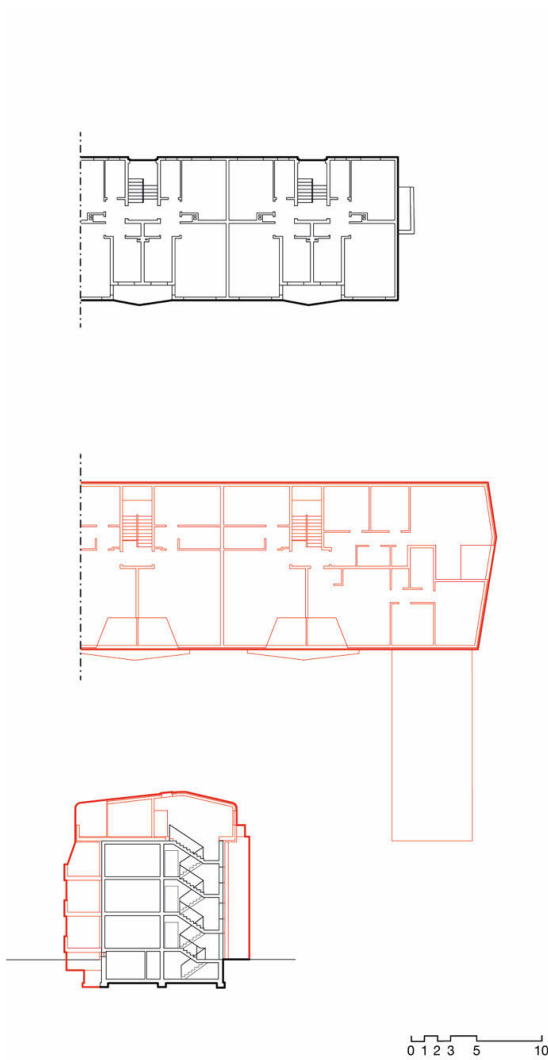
Grundrisse & Schnitte Bestand – Aufstockung 1,
